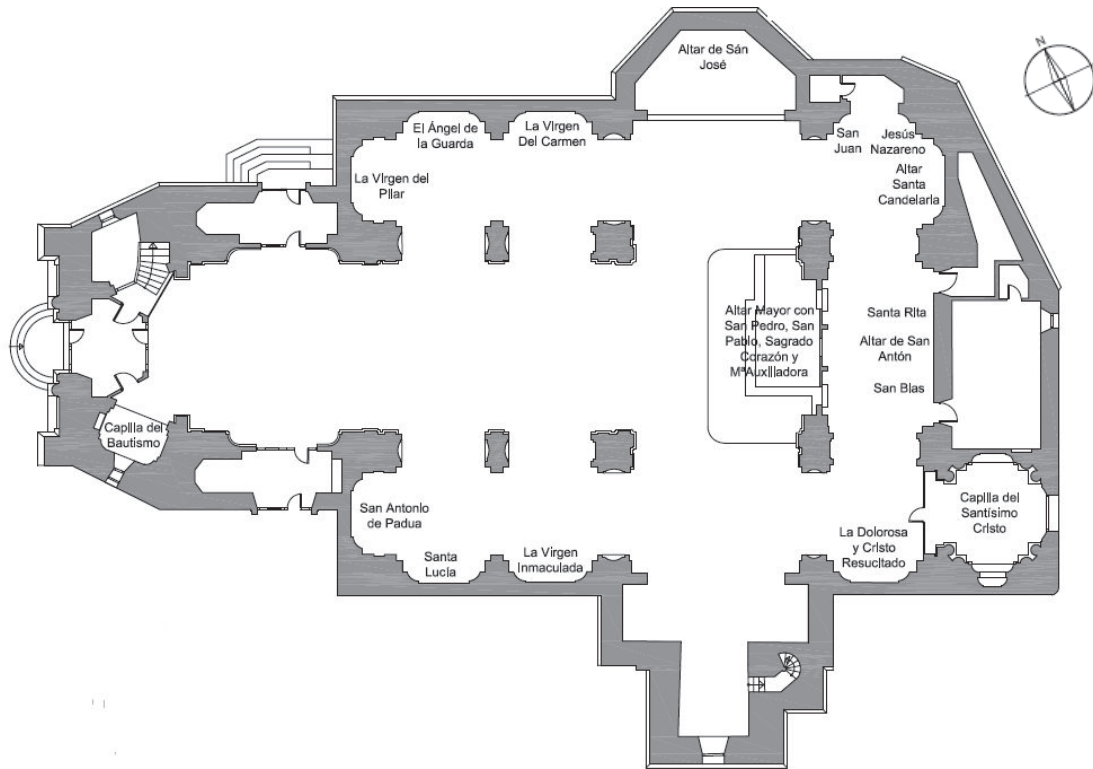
Plano de planta con indicación de altares (P-10). 2014. M^aNieves Pujol
